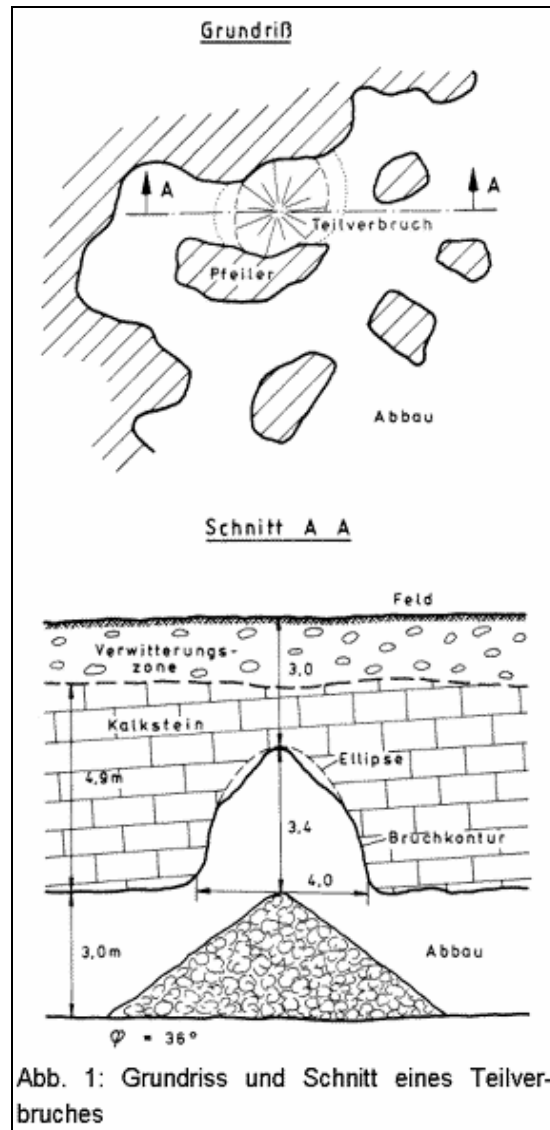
Grundriß und Schnitt eines Teilverbruches
